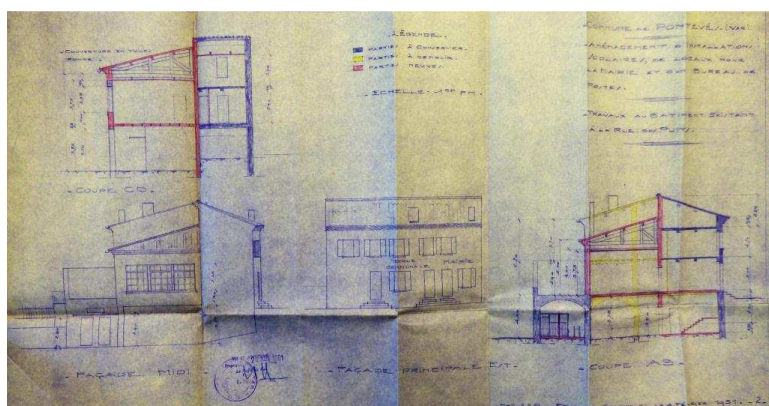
Groupe scolaire, façade principale, Barla Barthy (architecte).
